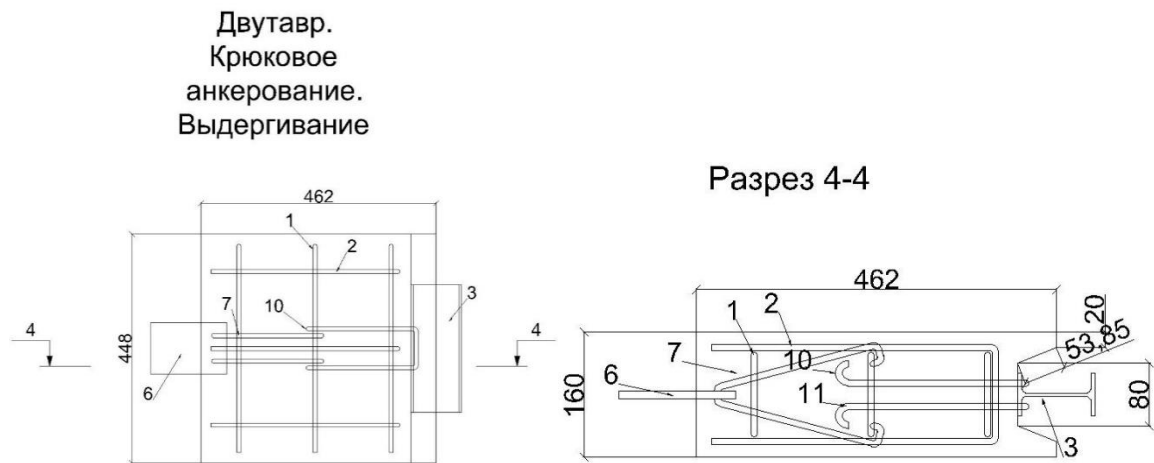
Схема фрагмента стеновой панели с крюковым анкерованием.
